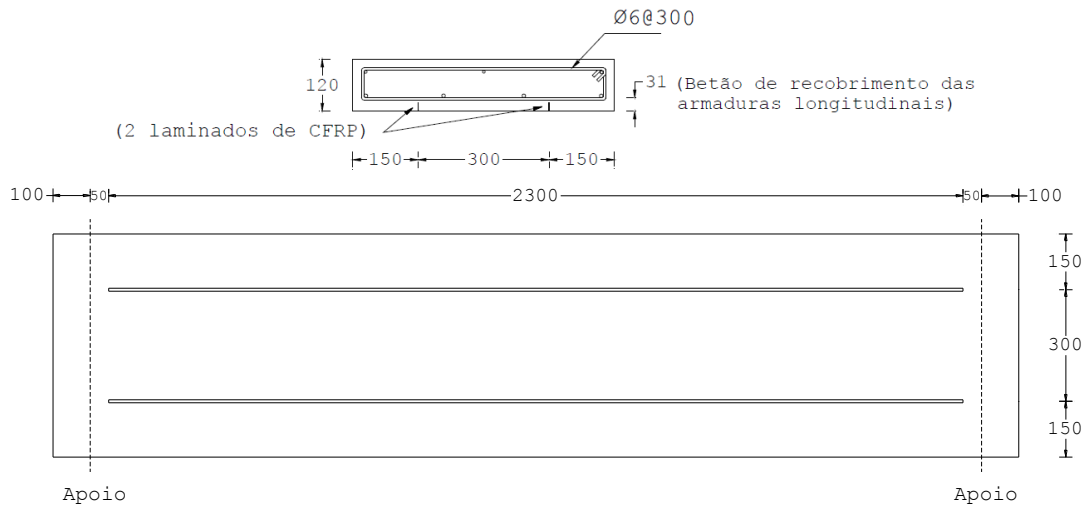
Solução de reforço de CFRP das lajes testadas (dimensões em mm).
